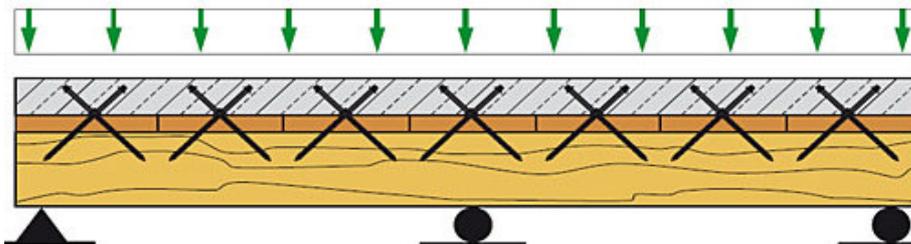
Holz-Beton-Verbunddecke<sup>142</sup>
